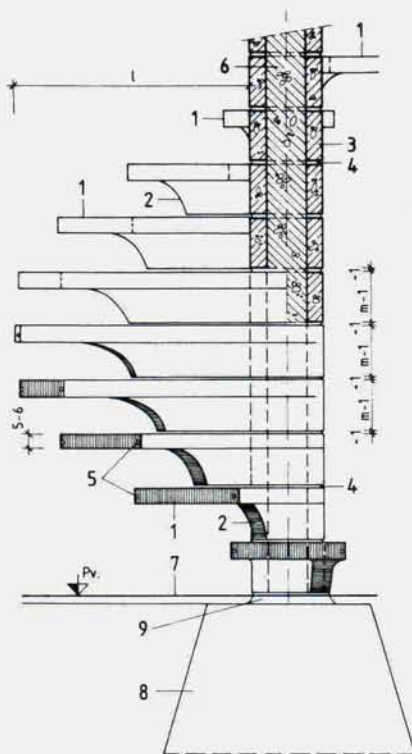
Железобетонная винтовая лестница со ступенями из сборных элементов
